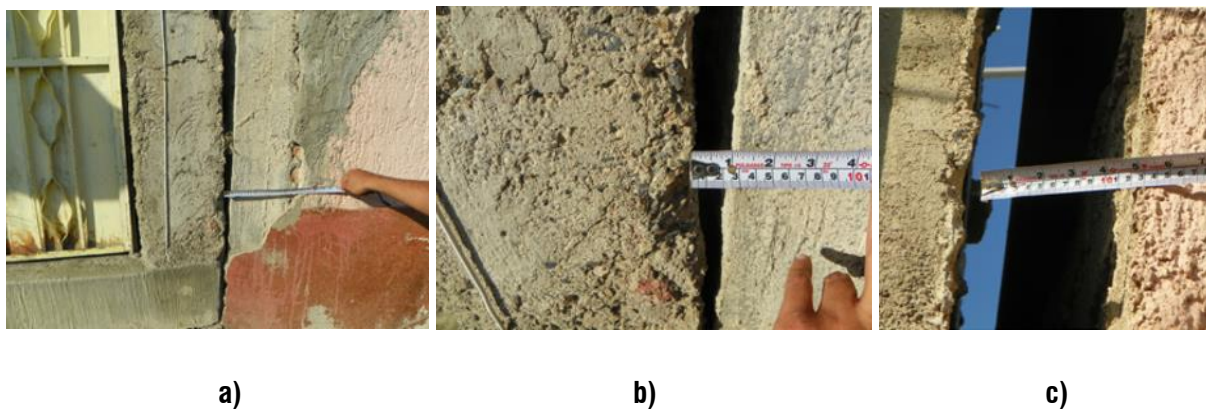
Separación de edificaciones colindantes; a) parte inferior de muros b) parte media de la apertura c) parte superior de la separación de muros.
